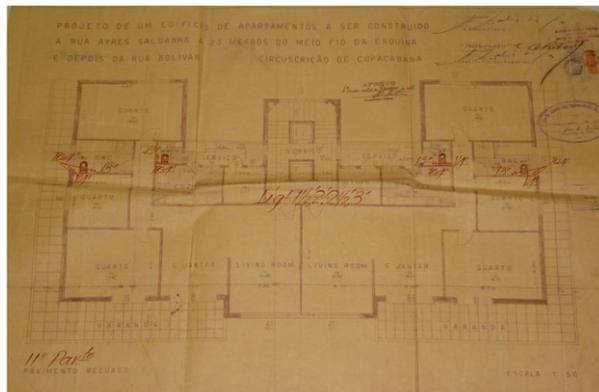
Planta do Pavimento Tipo do Edifício Rua Aires Saldanha, 16 (fonte: Autor).
